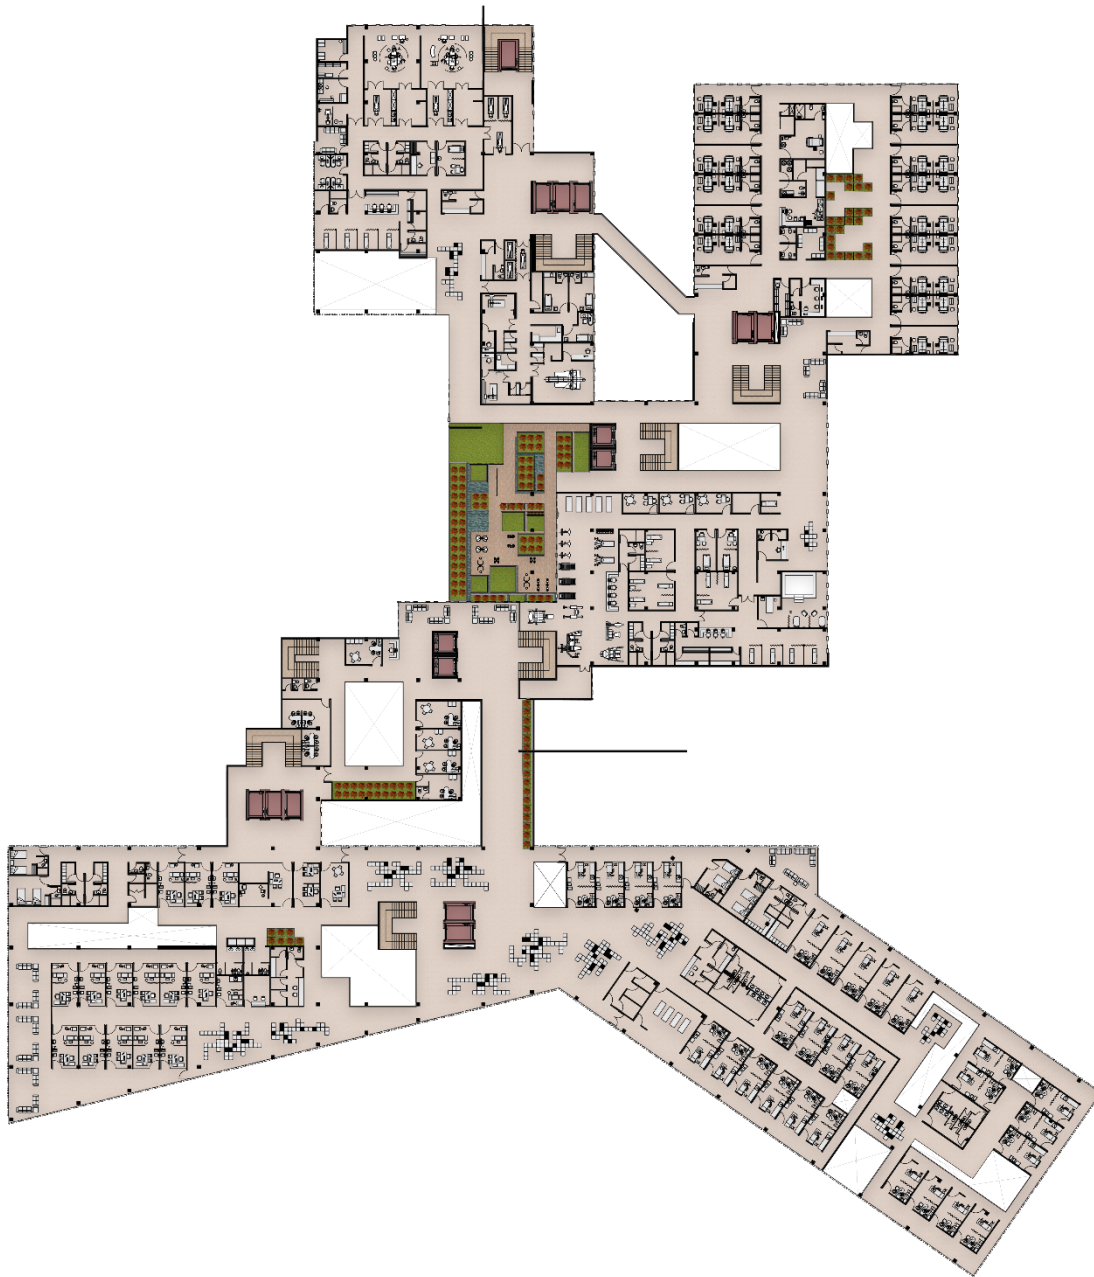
Planta 3er Piso. Nota: Distribución de la tercera planta. Elaboración propia: Photoshop
